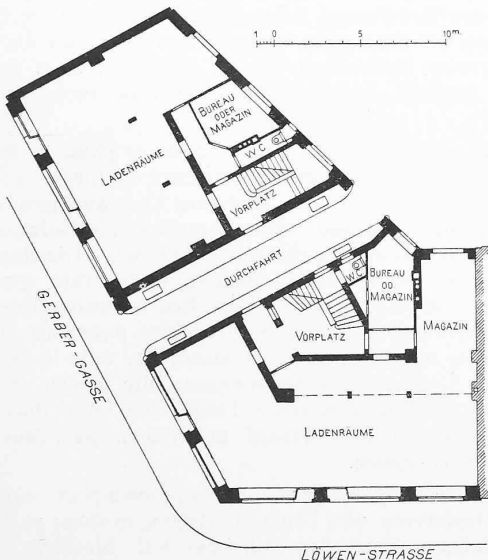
Grundriss vom Erdgeschoss.
